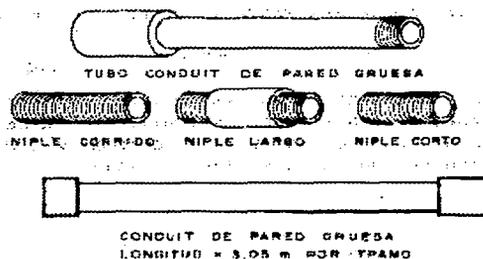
Tubo (conduit) metálico tipo pesado ó de pared gruesa
